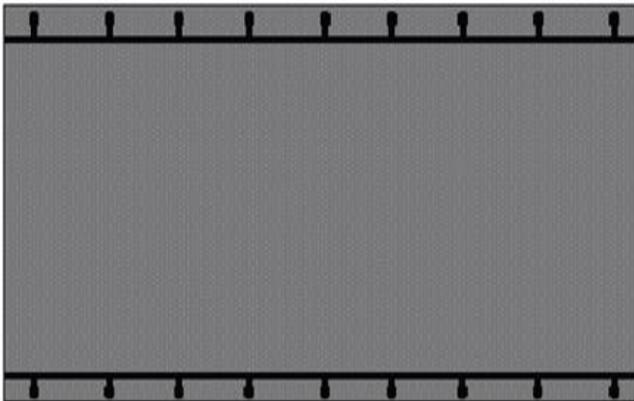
Tramo a pavimentar con líneas guía instaladas a cada lado.
